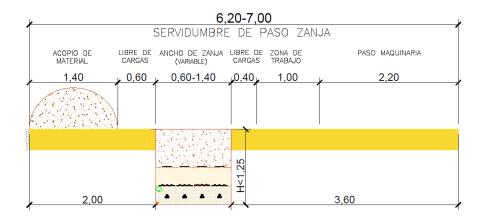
Sección transversal de detalle de servidumbre de zanja
